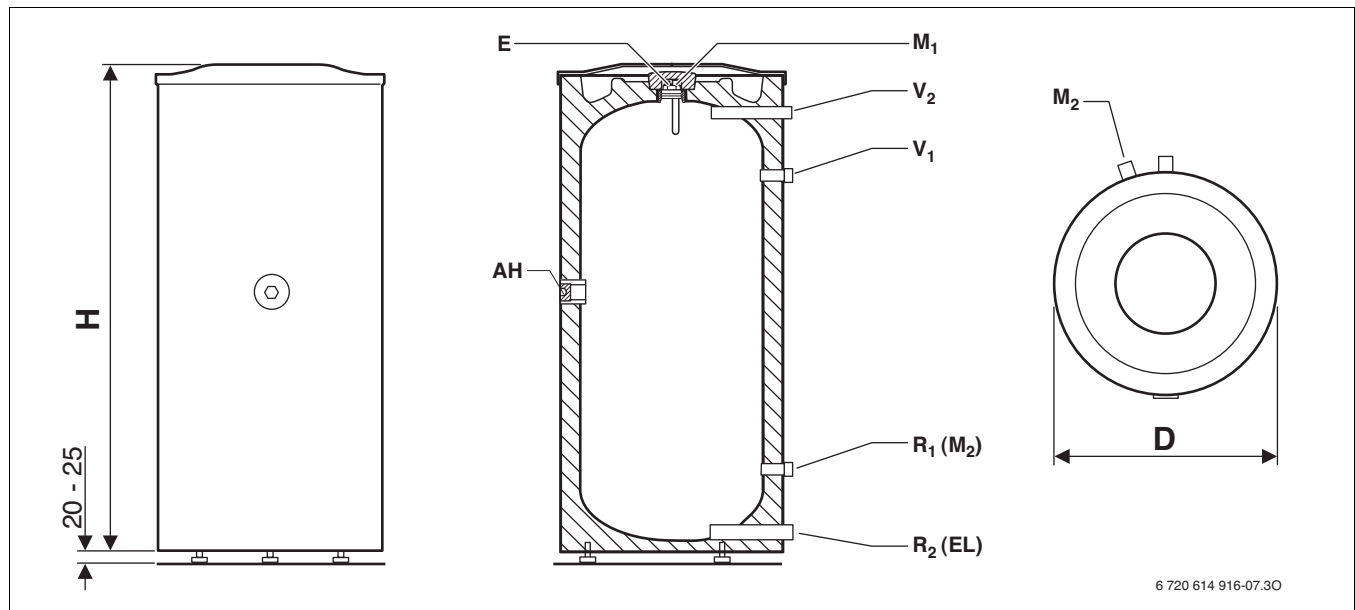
Bau- und Anschlussmaße Pufferspeicher PSW 200/300 (Maße in mm)
